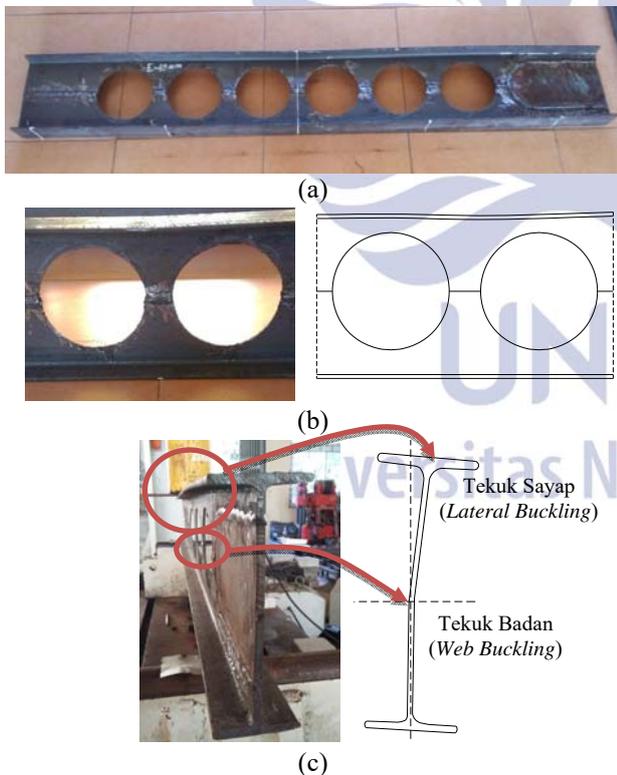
Pola runtuh benda uji e=60 mm (a) kondisi setelah pengujian; (b) tampak memanjang; (c) tampak melintang
